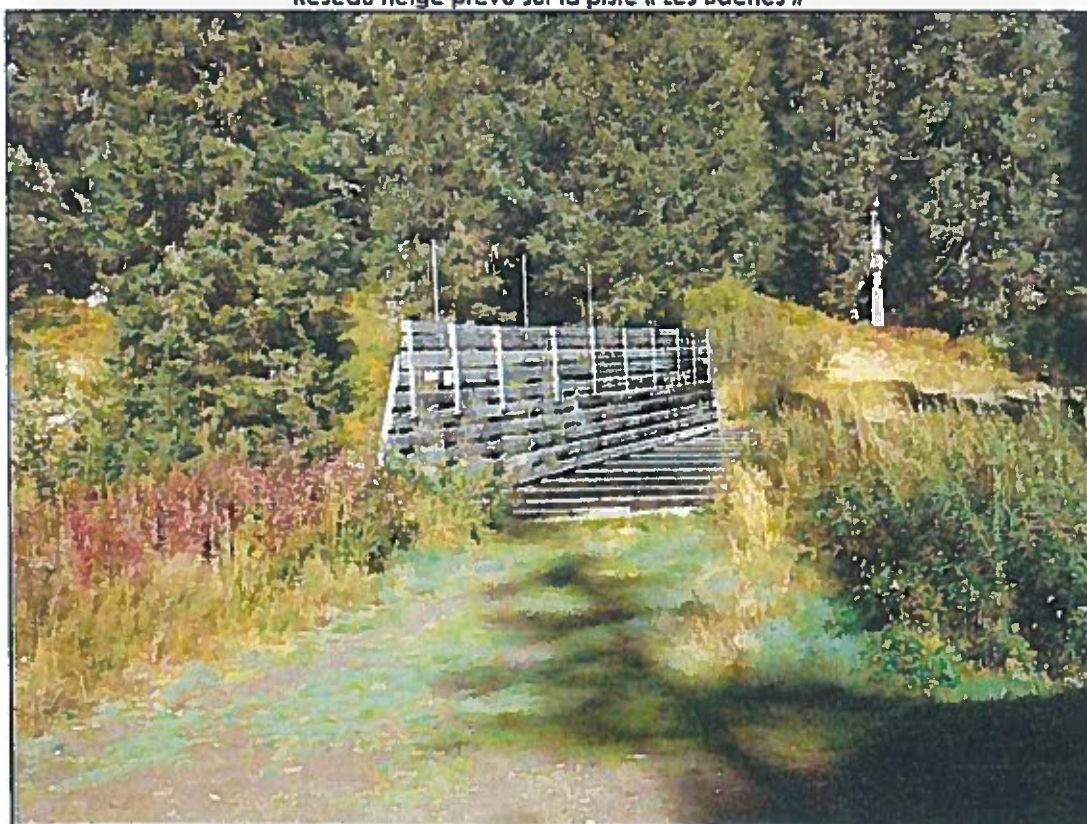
Piste carrossable et passerelle au-dessus du ruisseau
